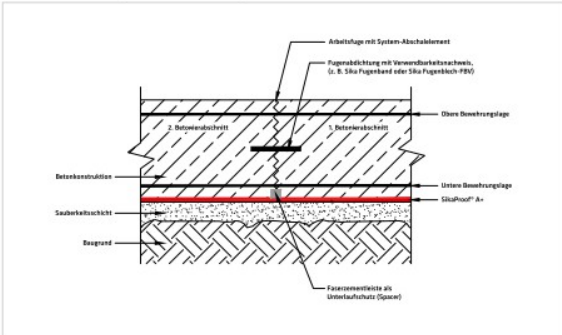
Verlegung auf Sauberkeitsschicht mit Schutzlage
